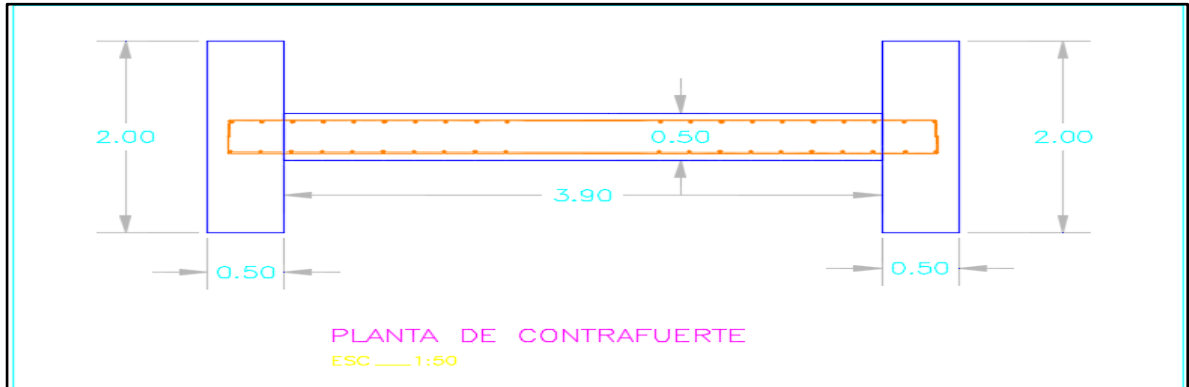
Diseño estructural espolón del contrafuerte muros de contención del Box coulver k34+190
